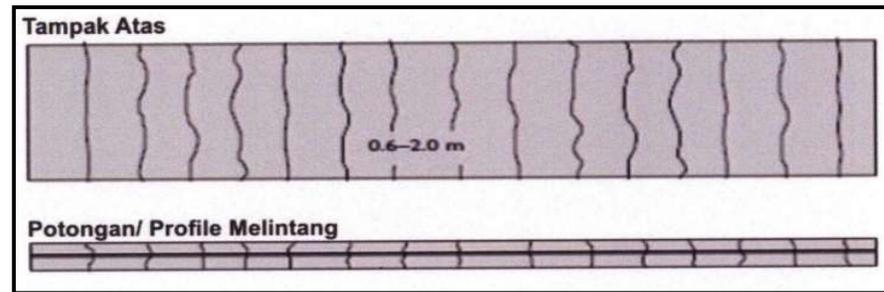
Perkerasan Beton Bersambung dengan Tulangan
